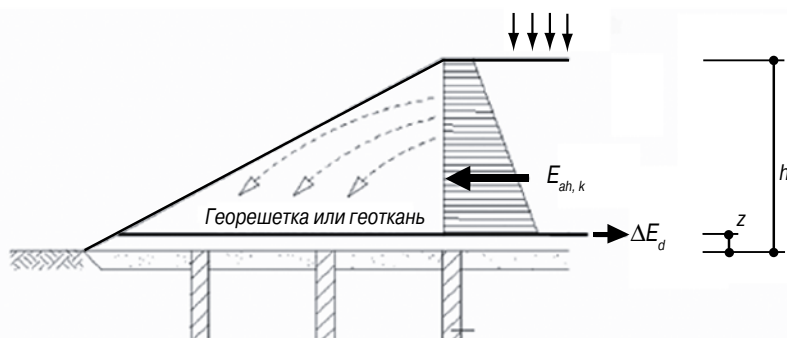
Дополнительные нагрузки на геосинтетическое армирование в насыпном теле
